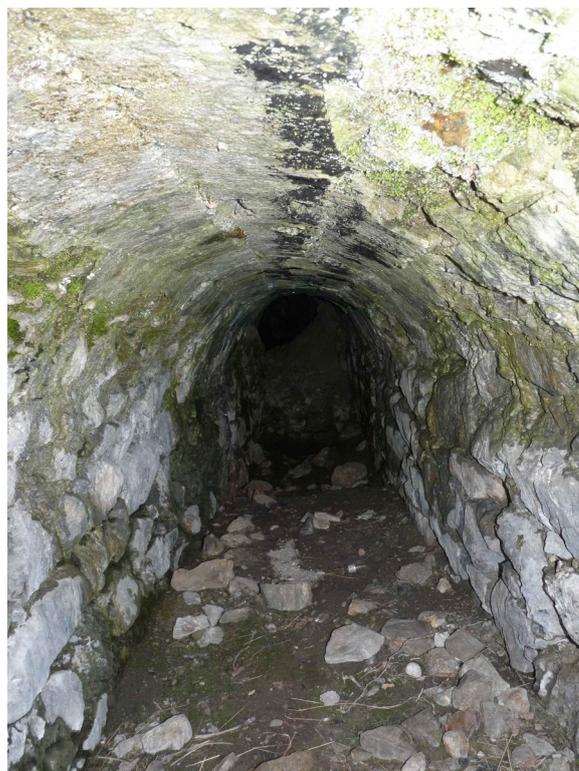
et 119: Tunnel de la conduite forcée traversant le site éboulée à quelques mètres de l'entrée (clichés B. Oury, 2012).
